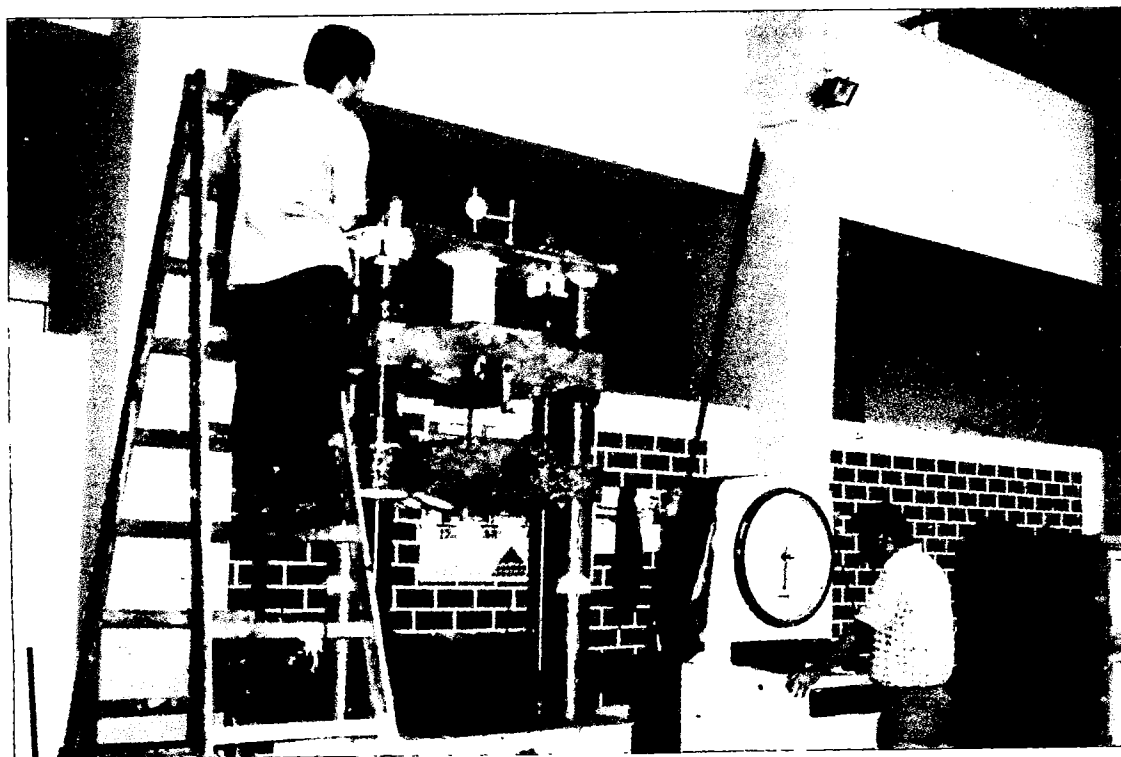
Ensayo para el cálculo de la Adherencia entre el Concreto y el Acero.
